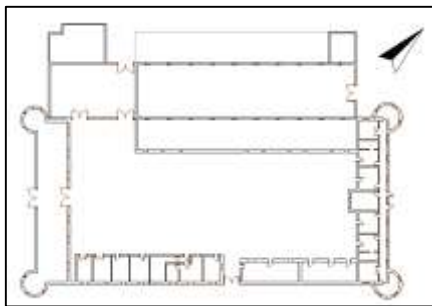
Plan état des lieux du rez-de-chaussée de la demeure/ Source : Sadi,2023 actualisé par auteur
